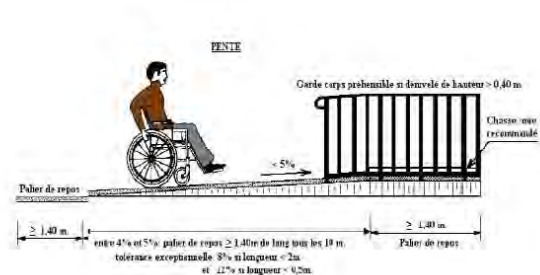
Normes d'installation des rampes d'accès conformément aux NCBS
